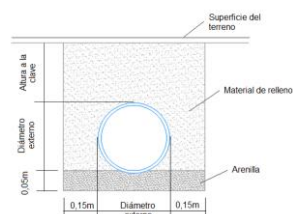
Instalación de tubería en zanja de alcantarillados no convencionales
